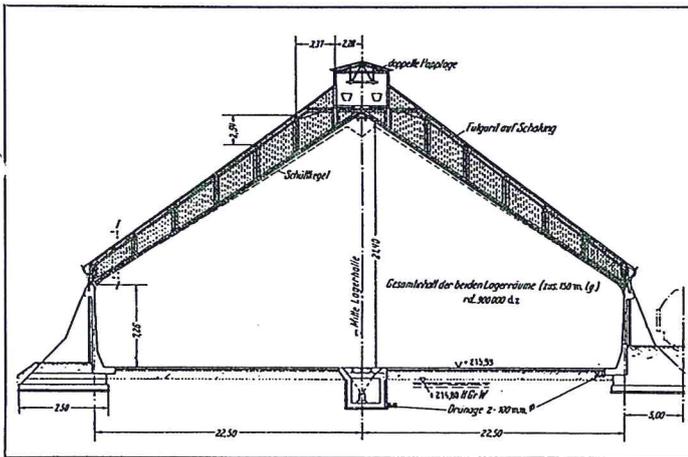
Holztragwerk für eine Kallagerhalle nach [22], errichtet 1938, Bauweise Cabröl
